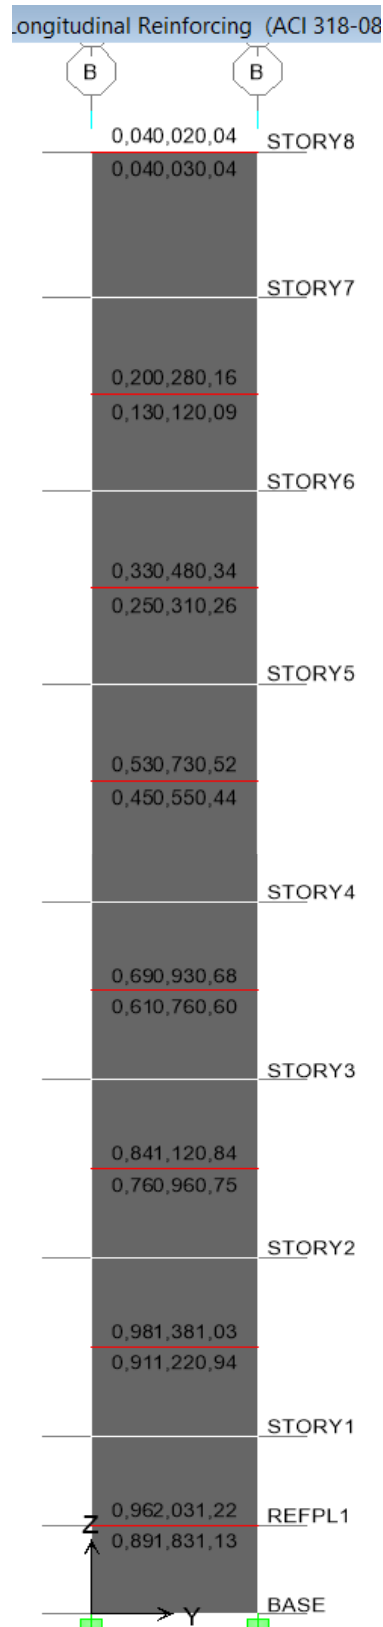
Acero en Vigas y Columnas en el Pórtico B – Escaleras de Emergencia Hospitalización 2- (NEC-11)
